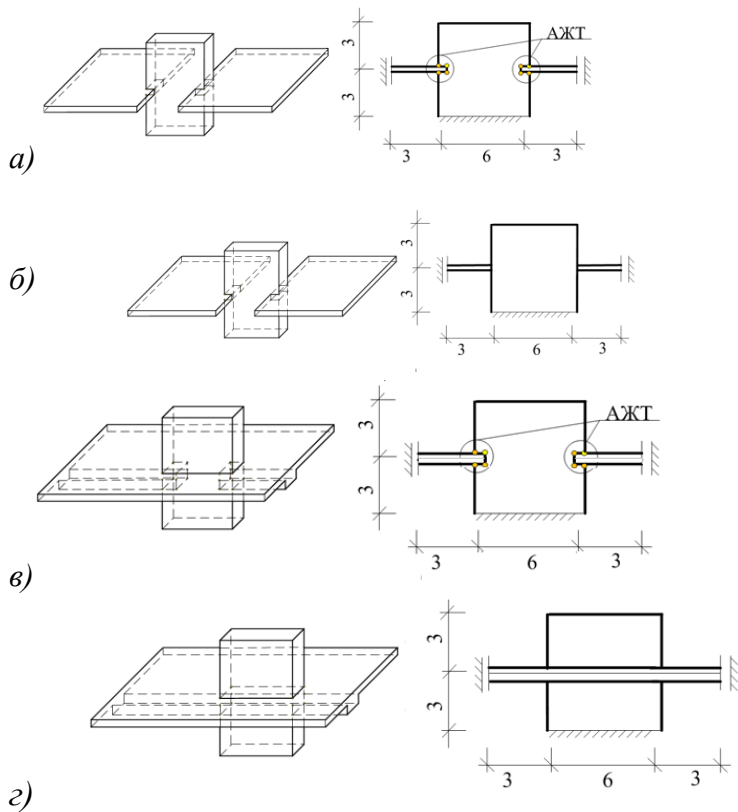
Моделирование примыкания перекрытия к диафрагме
